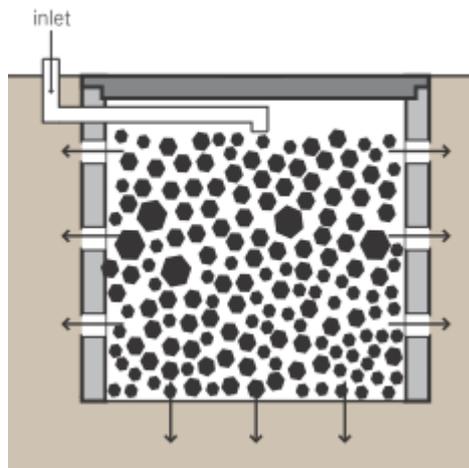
Planta e corte de um poço de infiltração. Fonte: Bartolomeu, 1996.
